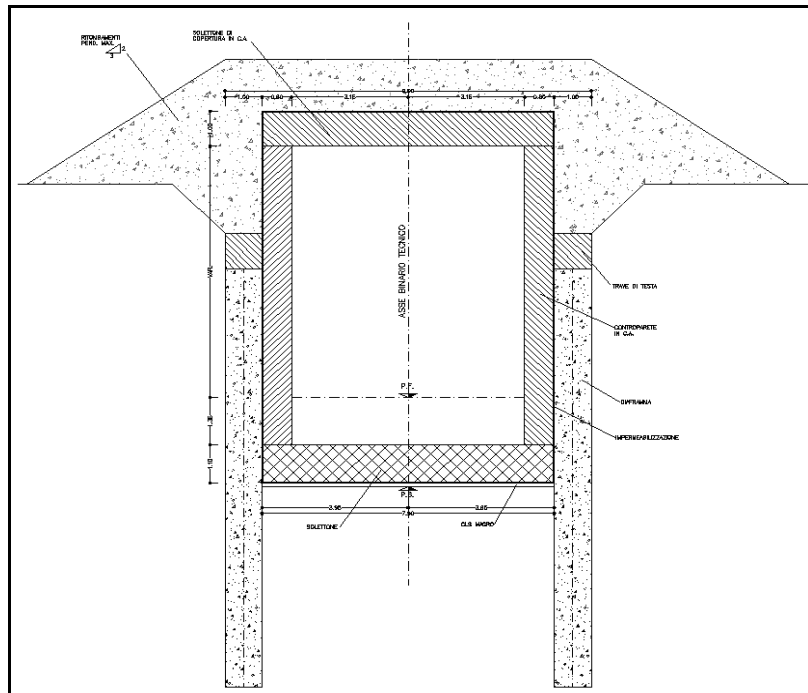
E Sezione tipo Galleria artificiale tra diaframmi e soletta di copertura realizzata previo scavo (sezione tipo "3")
